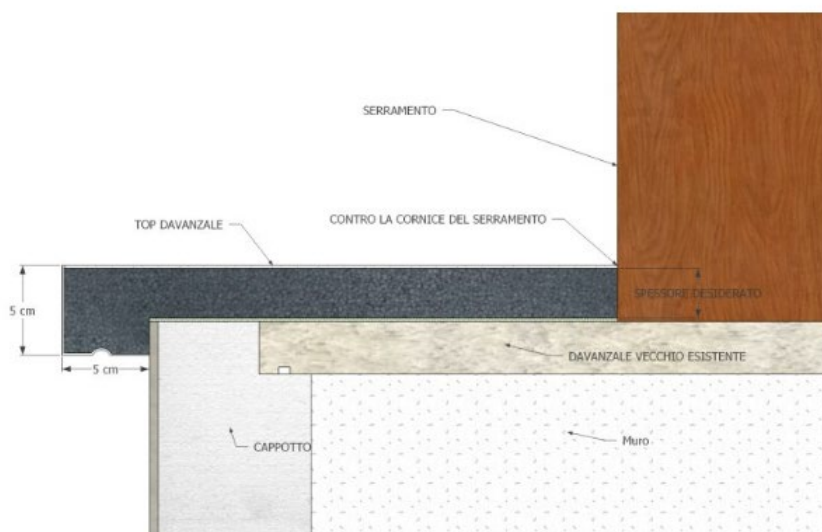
\_Dettaglio posa davanzale coibentato (Wall System)
